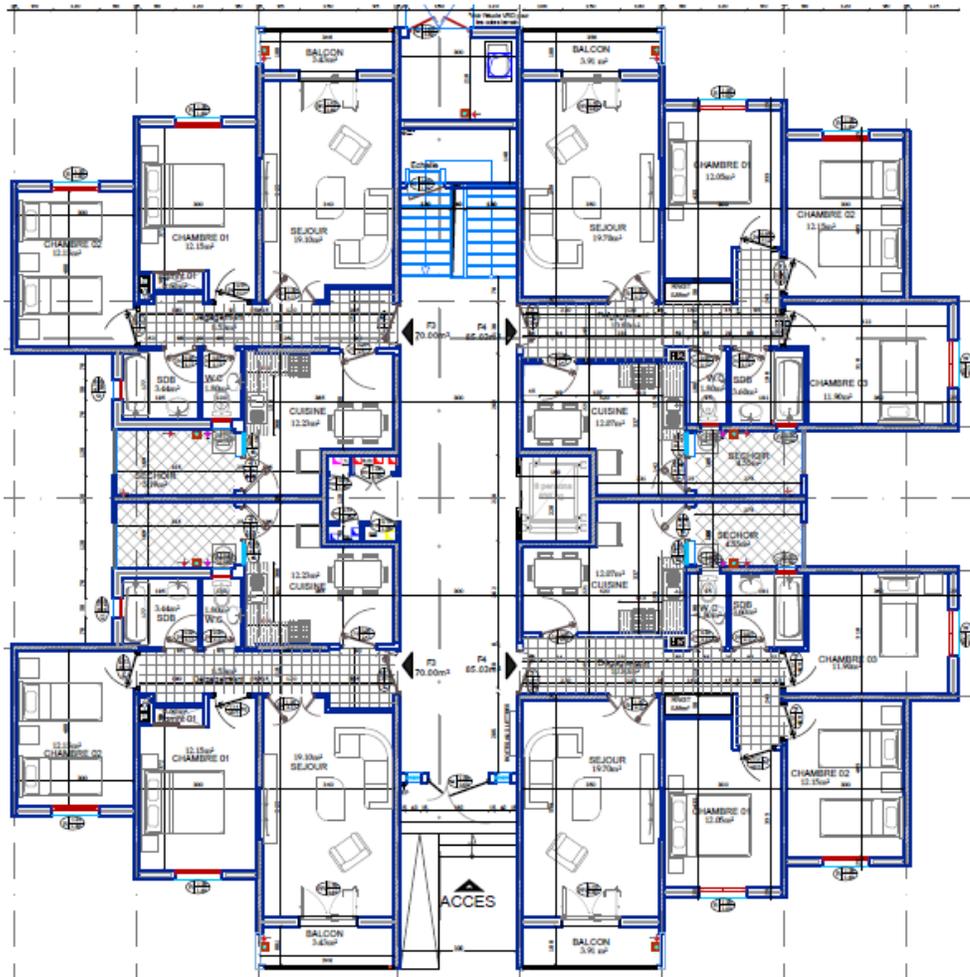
Plan d'un bloc à l'AADL de Sidi Abdallah
